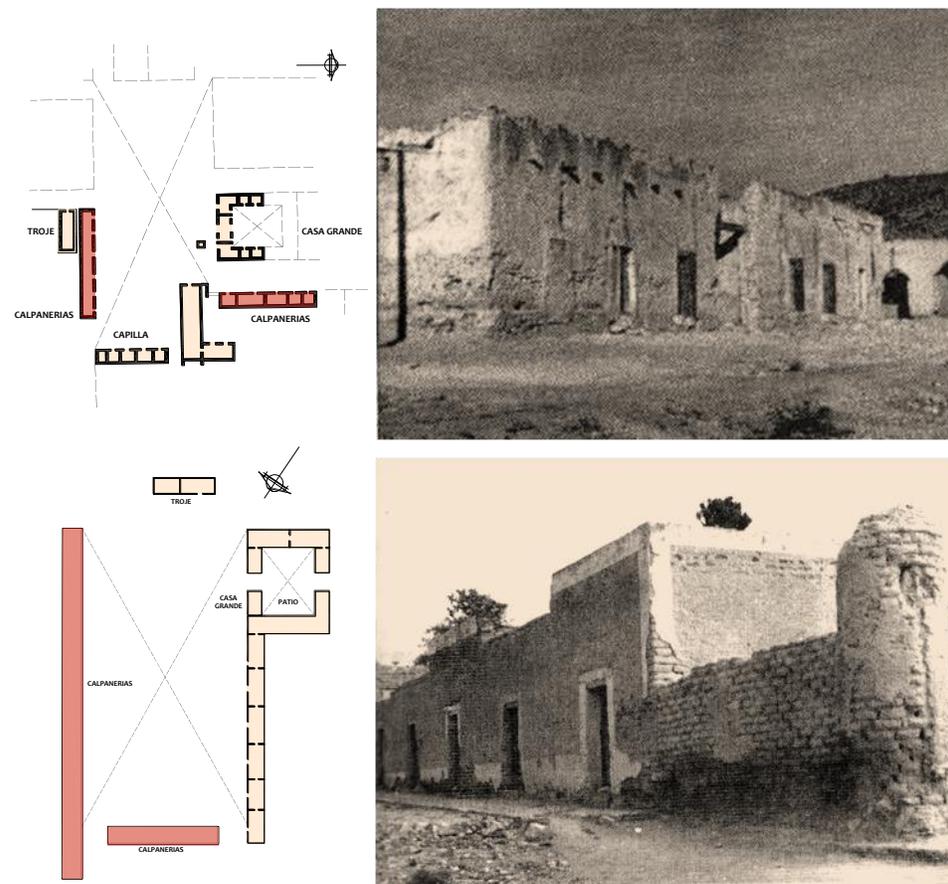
Calpanerías Aisladas. Ubicación y fachada de las calpanerías de la hacienda de Boquillas, municipio Dr. Arroyo, Nuevo León.
